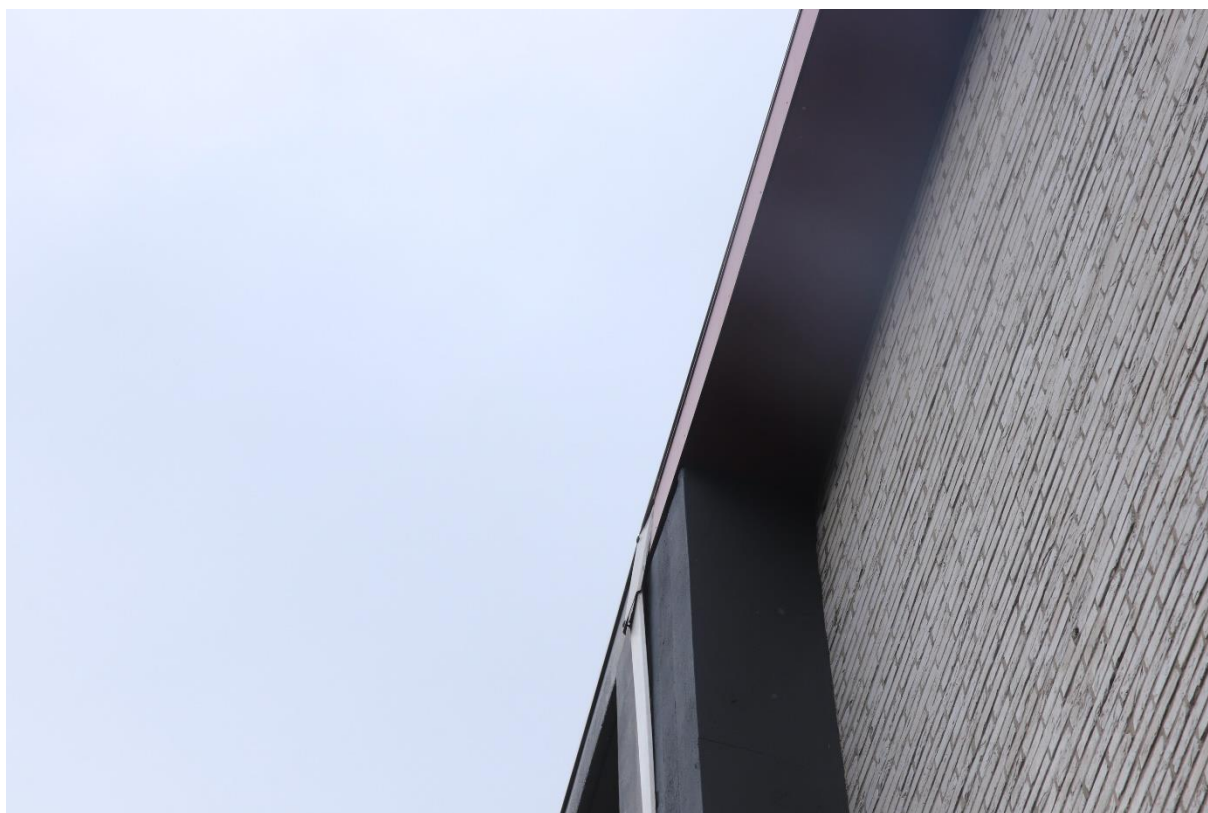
Er zijn geen geschikte invliegopeningen aanwezig voor vleermuizen in het pand en de dakrandconstructie.
